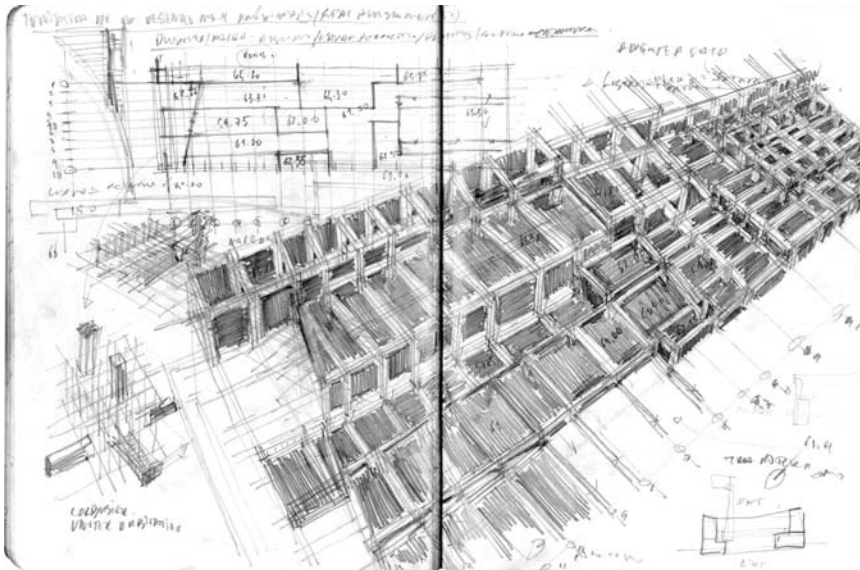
Esboço da estrutura: 'Grelha estrutural'.
